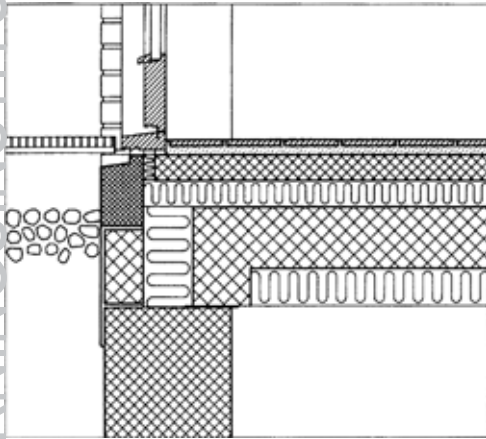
Krybekælderdek af letklinkerbetonelementer med påstøbt isolering. Kun en mindre del af isoleringen må anbringes over fugtspærren.
